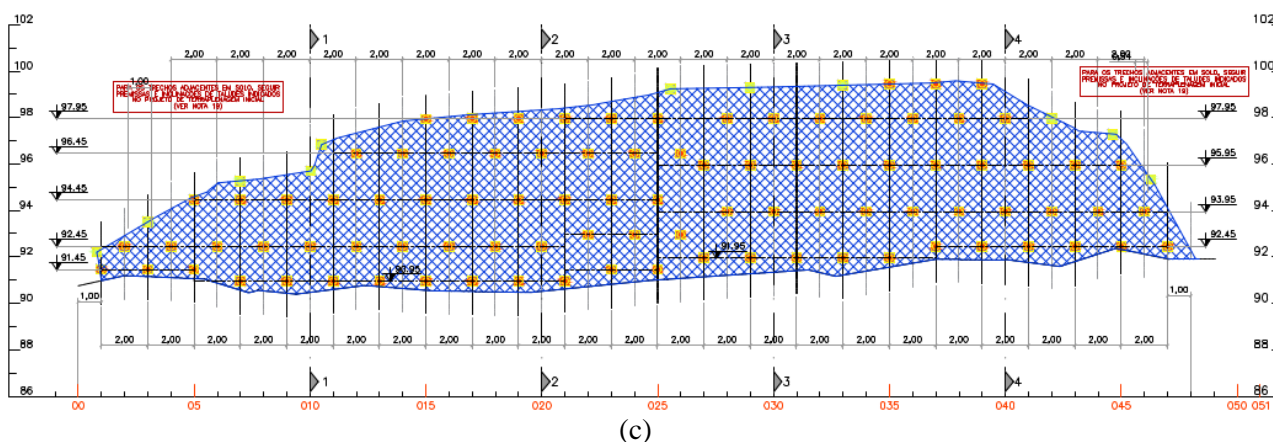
(continuação) Projeto Elaborado em (a) planta, (b) uma seção em corte e (c) a elevação frontal.
